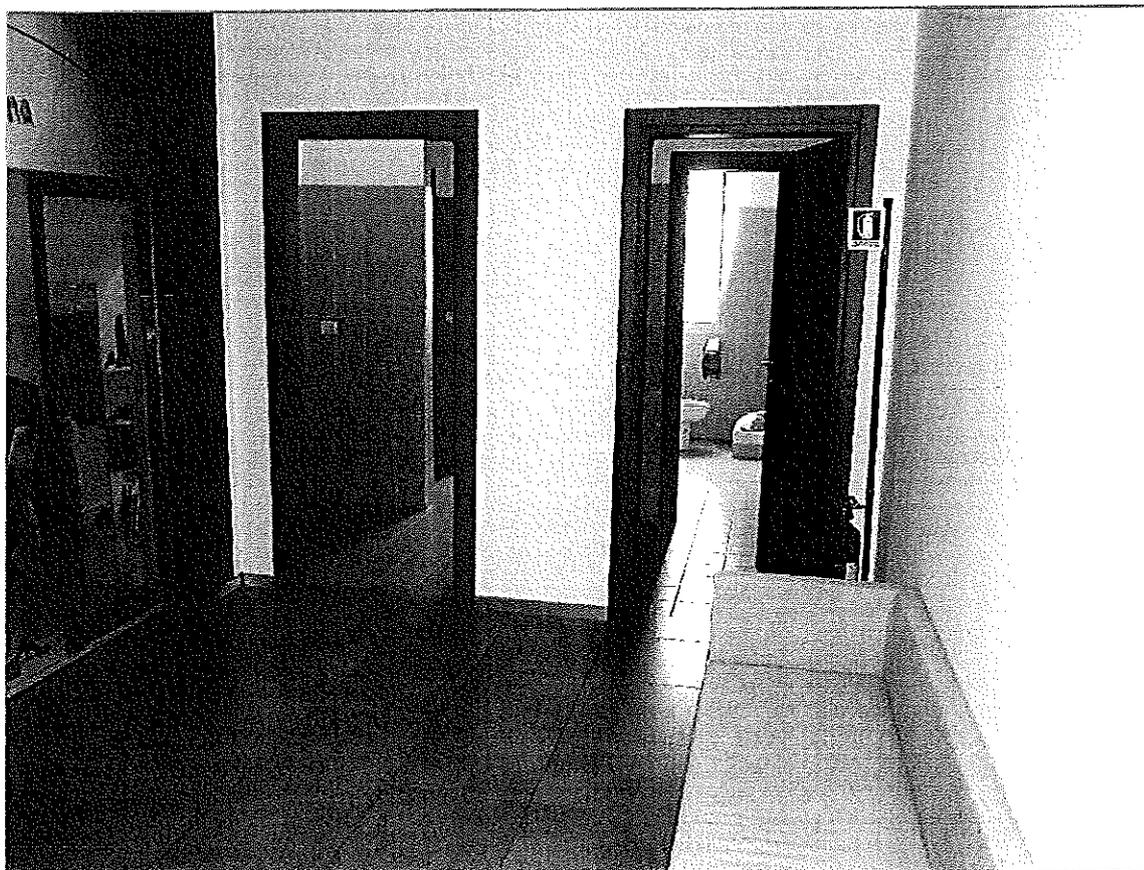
Opificio -Piano Primo - servizio igienico - lavabo non installato
